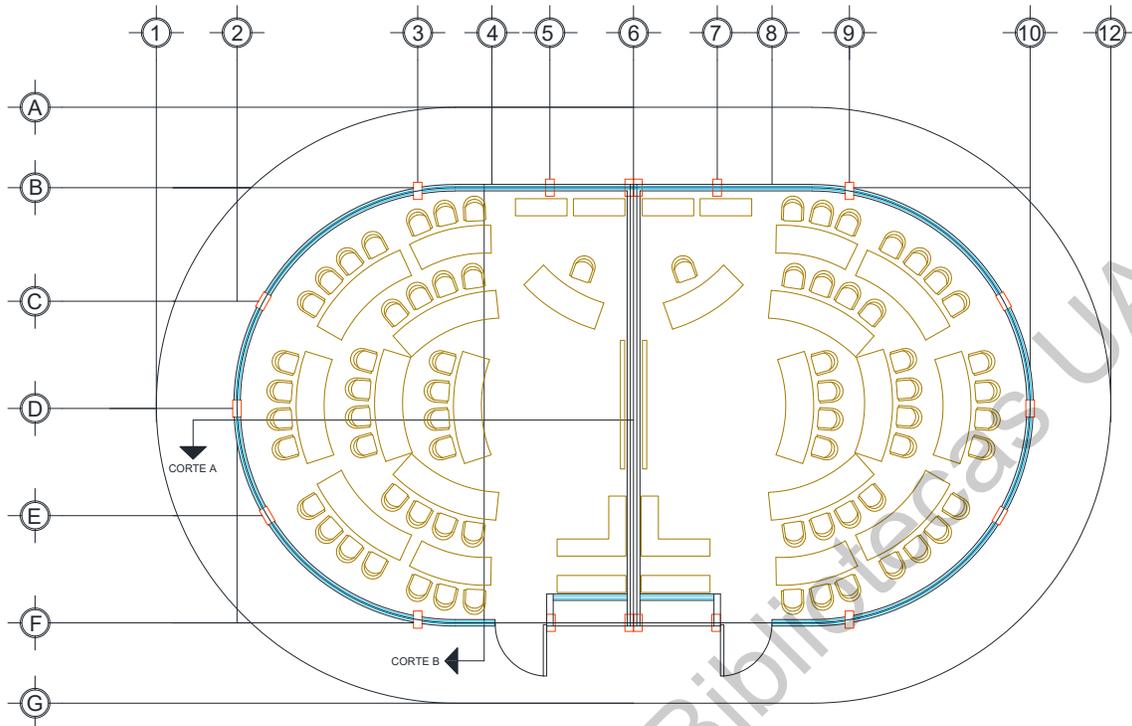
Planta Arquitectónica Zona A (Elaboración Propia)
